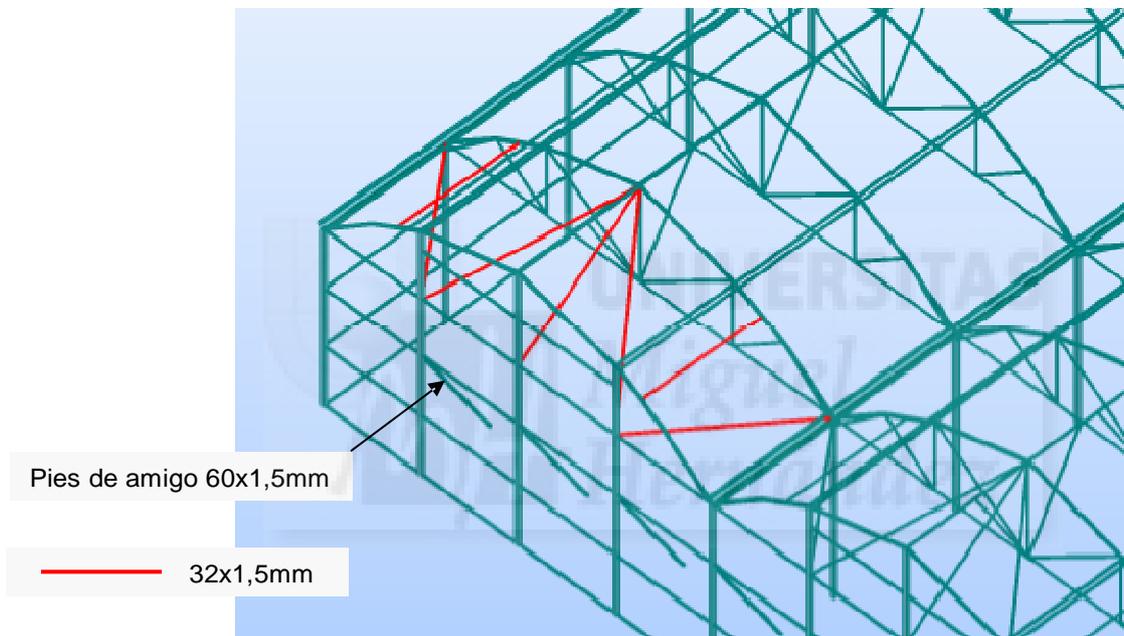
Vista 3D de perfilería de refuerzo en pórticos piñón.
